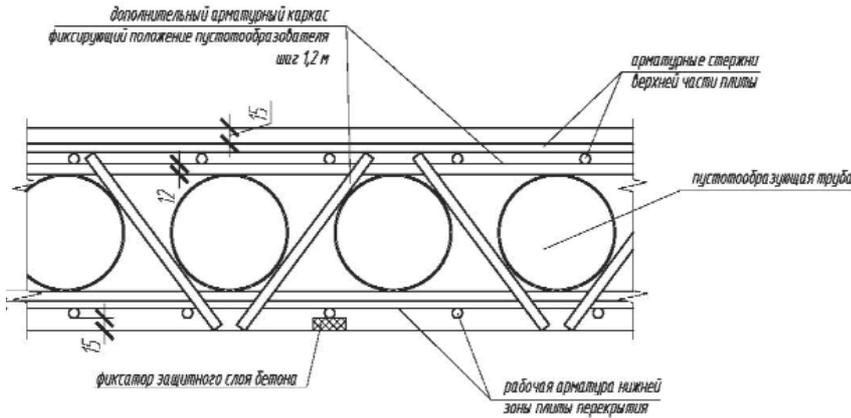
Устройство монолитного перекрытия с пустотами в виде труб
